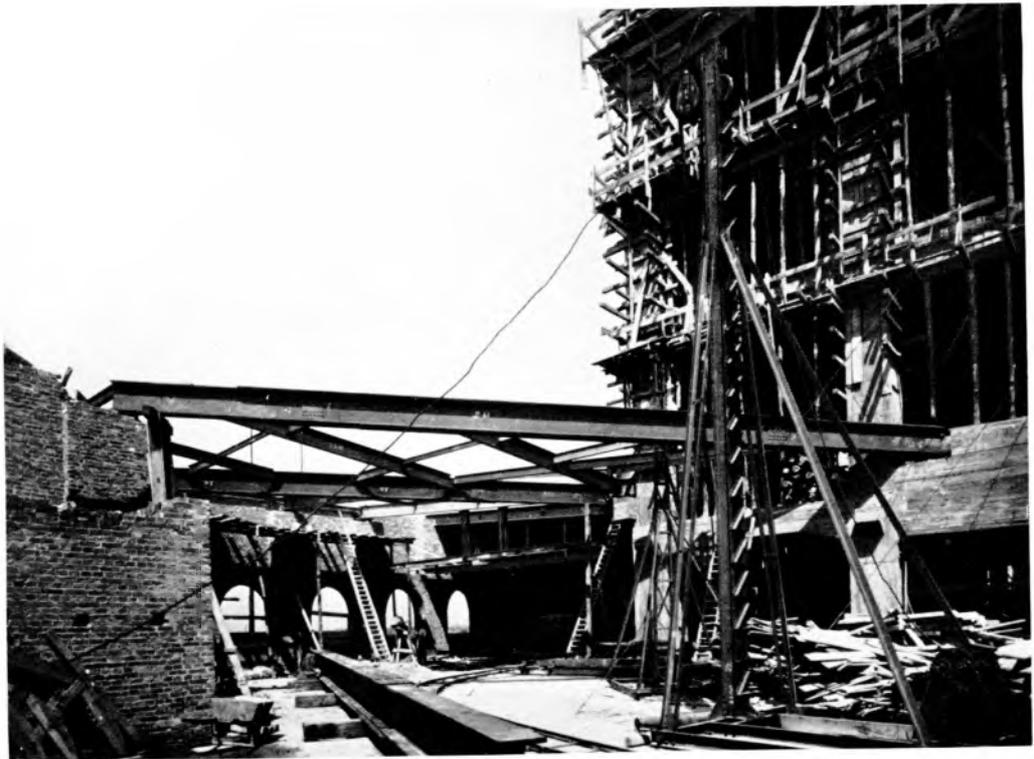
Aufstellen der eisernen Dachkonstruktion für Bauteil II am Turm
